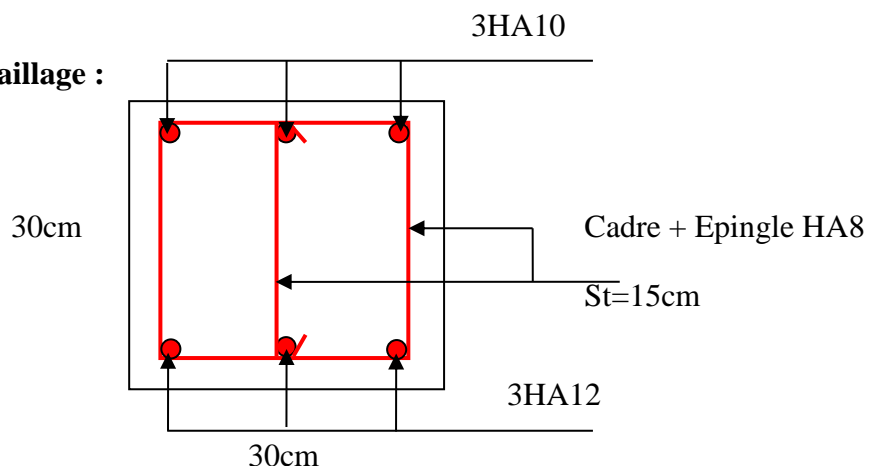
Schéma de ferrailage de la poutre de chaînage.
